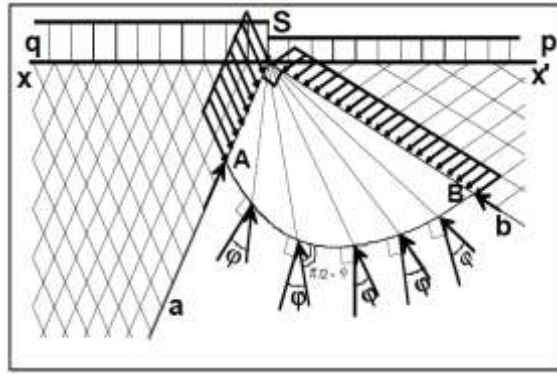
État d'équilibre de la zone de prandtl d'une fondation de base lisse (Prandtl (1920).
